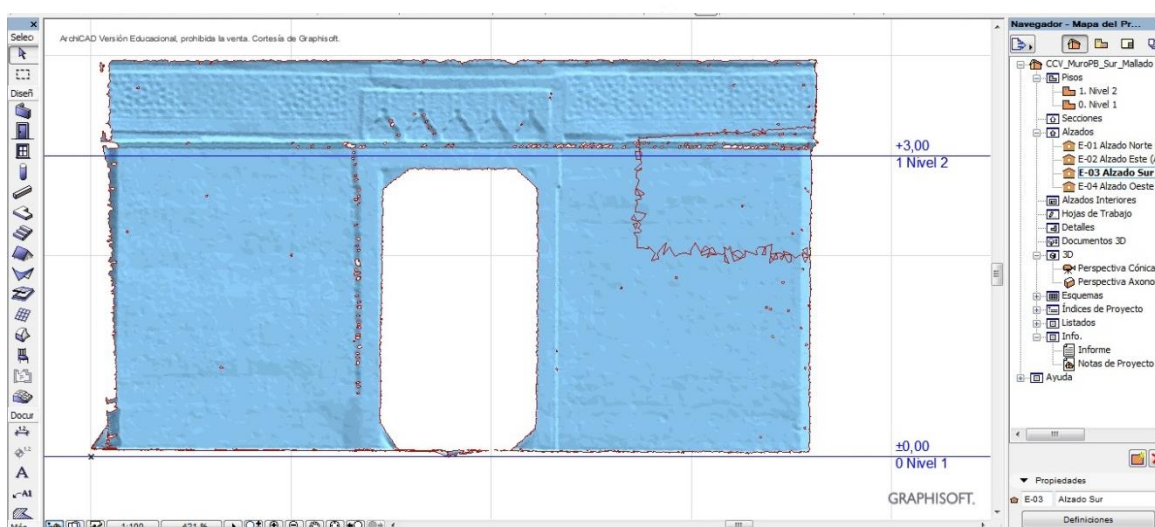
Alzado Muro PB-Sur Mallado con la superficie en Colores Propios de ArchiCAD (gsm).
